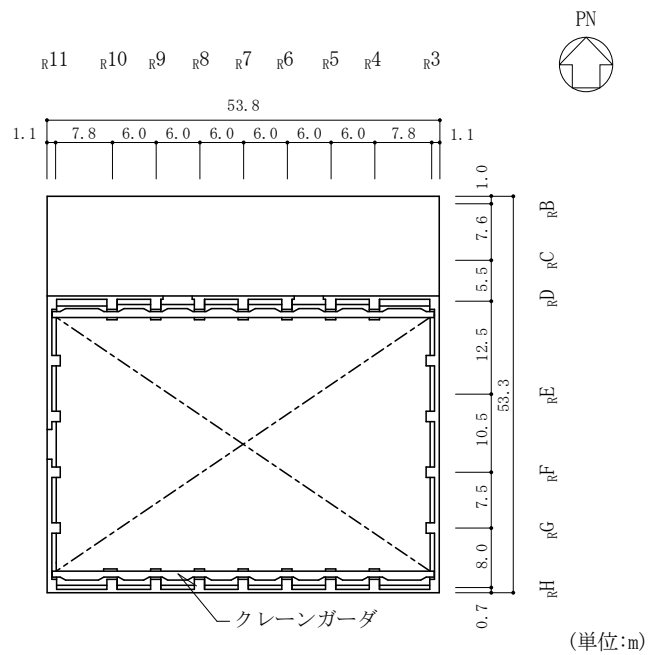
(8) 原子炉建物の概略平面図 (EL 51.7m)
